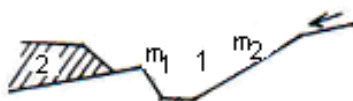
Конструктивная схема поперечного сечения нагорного канала: 1 – сечение канала; 2 – кавальер
